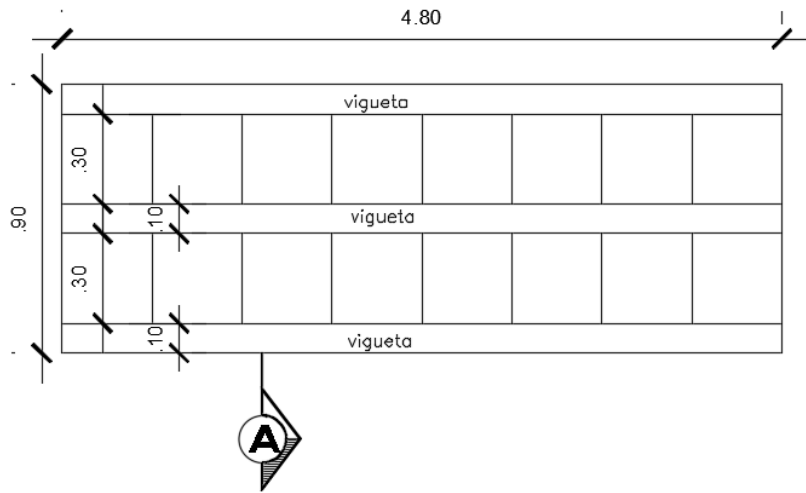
Vista de planta de losa aligerada para el ensayo (Fuente: Elaboración Propia)
